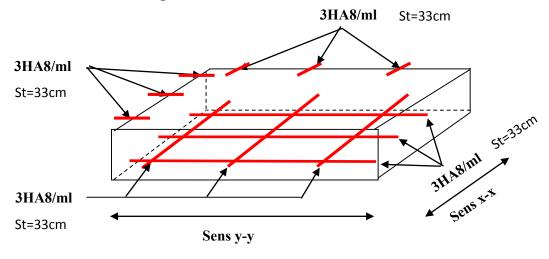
Schéma de ferraillage de la dalle pleine sous l'ascenseur
